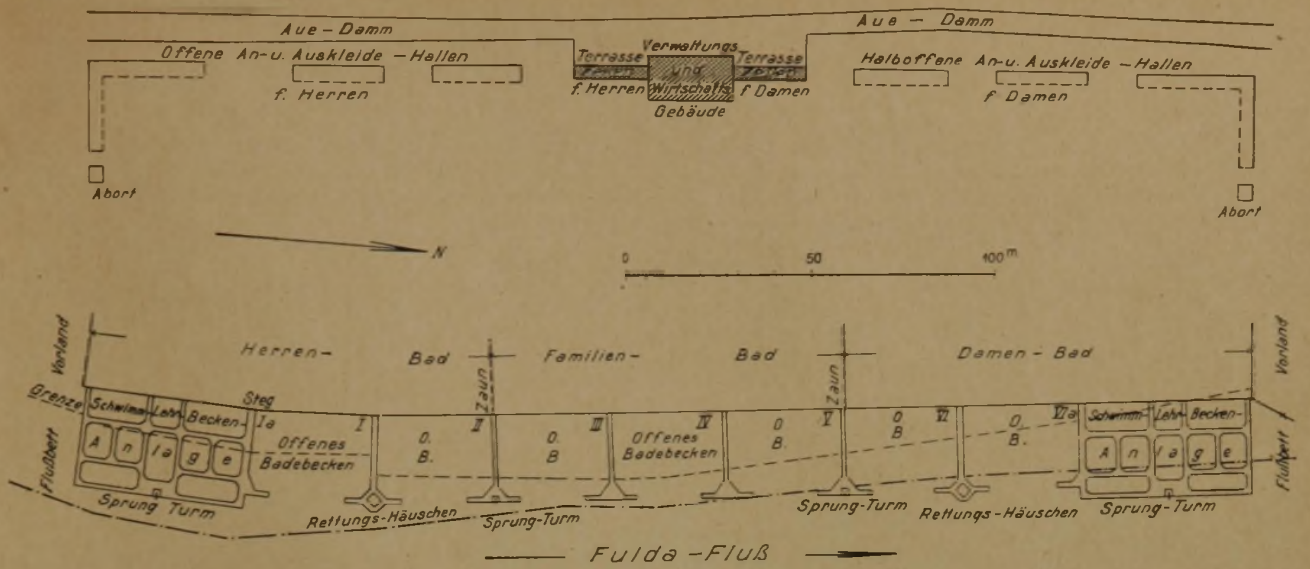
Lageplan der Flußbadeanstalt. (1 : 2000.)
